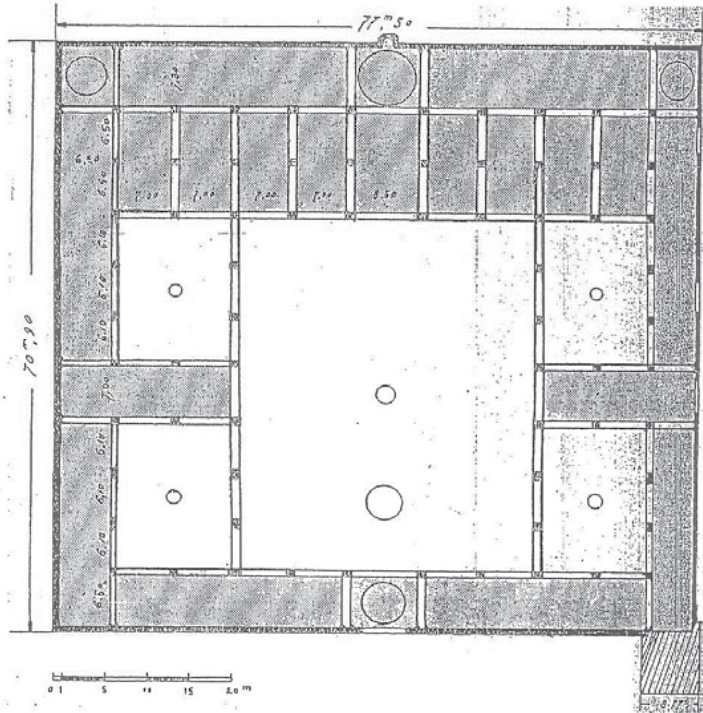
جامع تينمل، مسقط أفقي، عن:
